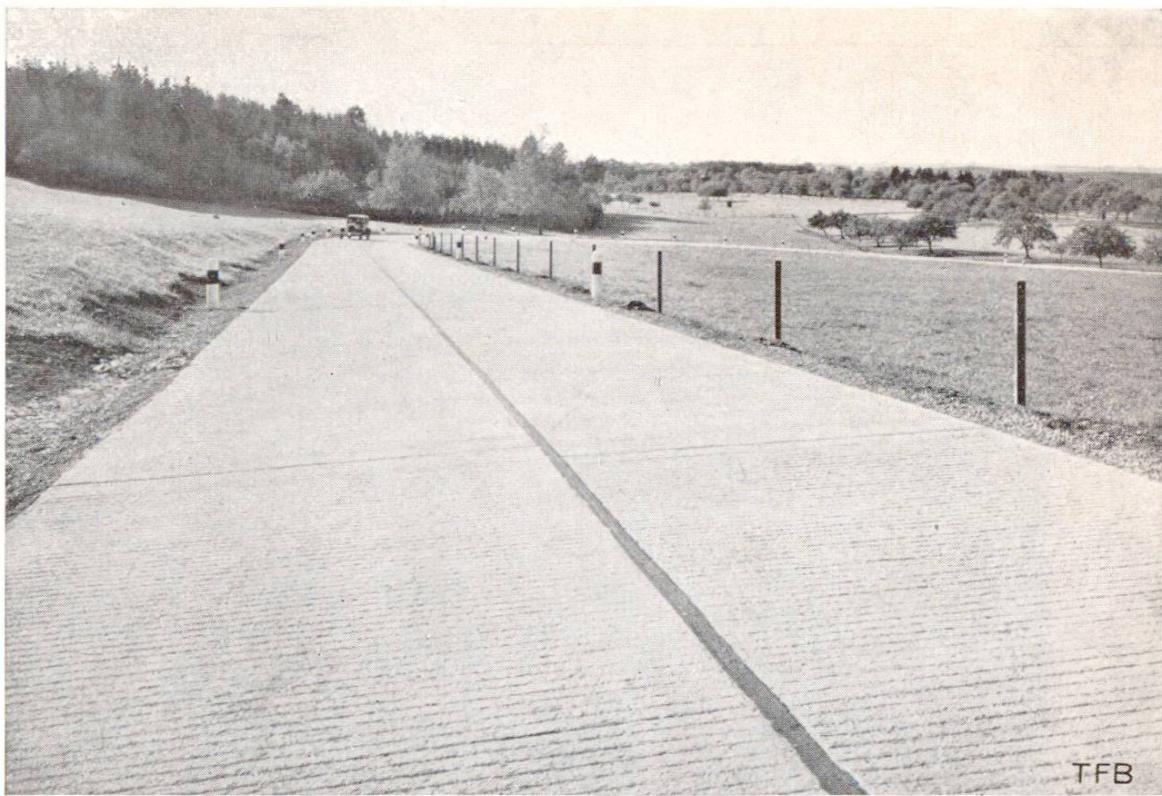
Route de Neukirch à Winden (Ct. de Thurgovie), 19466 m², construite en 1933. Revêtement en béton de 16 cm. d'épaisseur, fortement strié à la surface. Pente 5,5‰.
